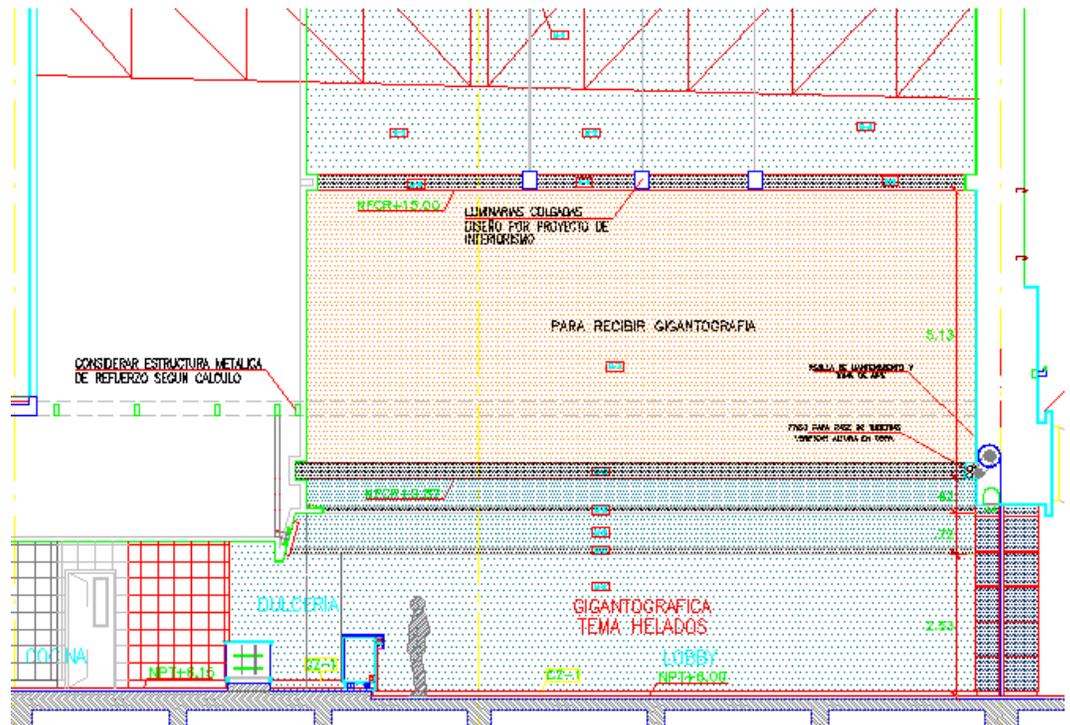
Vista de corte de lobby 2. Plano de arquitectura.
